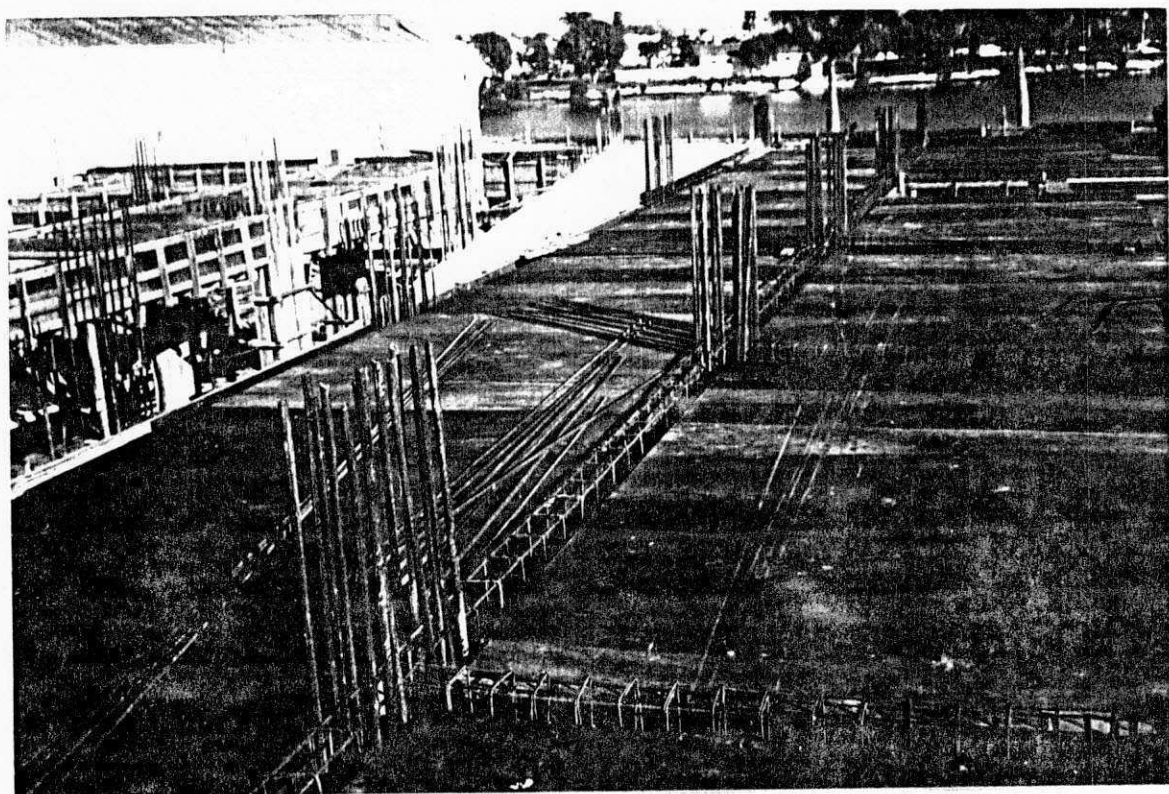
FORMAS PARA CONCRETO ARMADO
